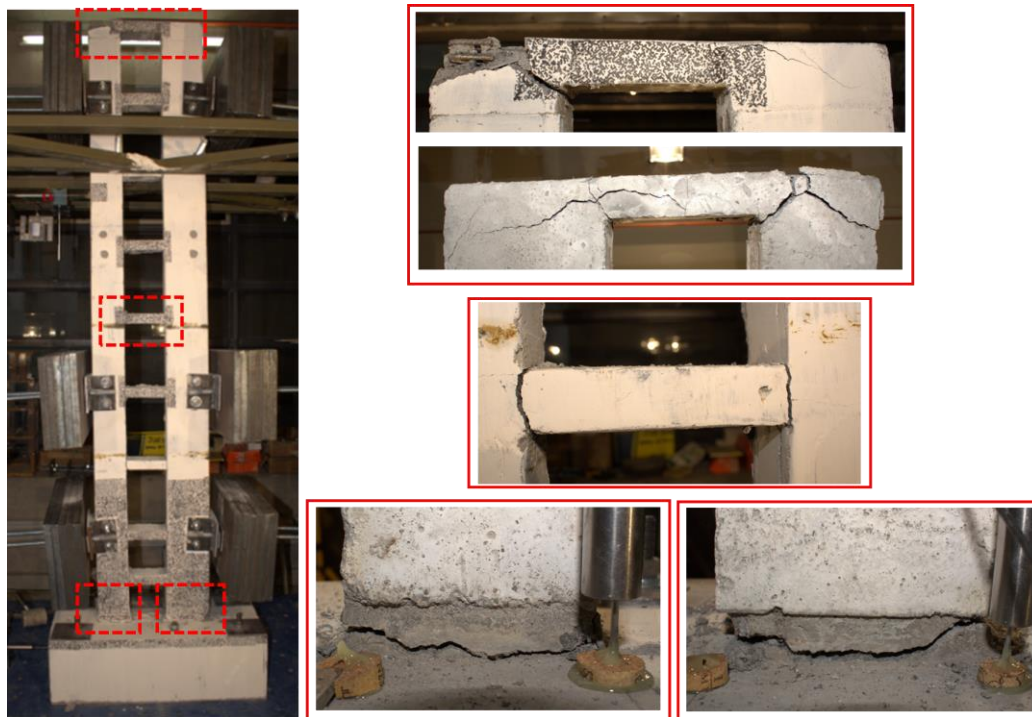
Detalle de fisuras en la parte superior de la probeta (por la cara del frente y posterior); grietas de flexión en la 5ta viga; y fisuras en la base de ambos muros – Probeta 2
